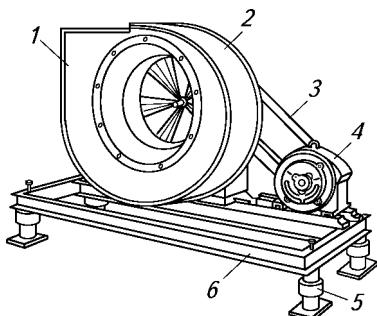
Общий вид вентиляторной установки на виброизолирующем основании:
